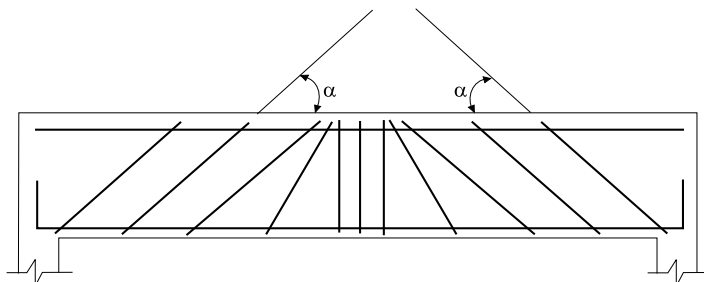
Representação esquemática da disposição dos estribos da viga.
